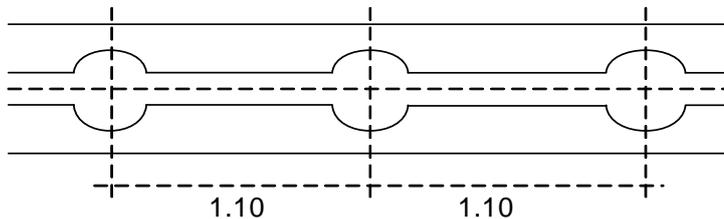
Typische Lamellen-Anordnung einer Schmalwand mit Tiefenrüttler
